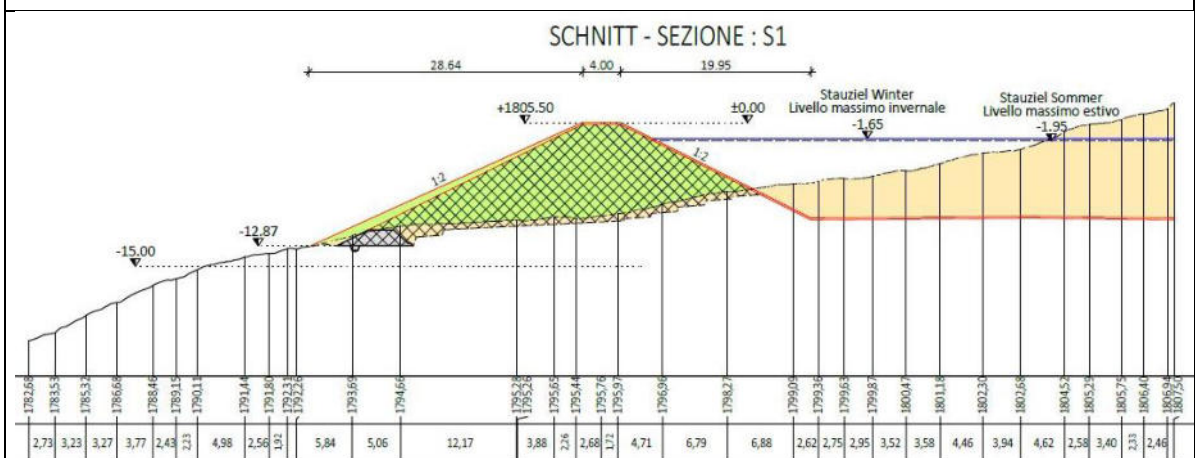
Auszug aus dem Projekt: Schnitt S1 / Stralcio da progetto: sezione S1
